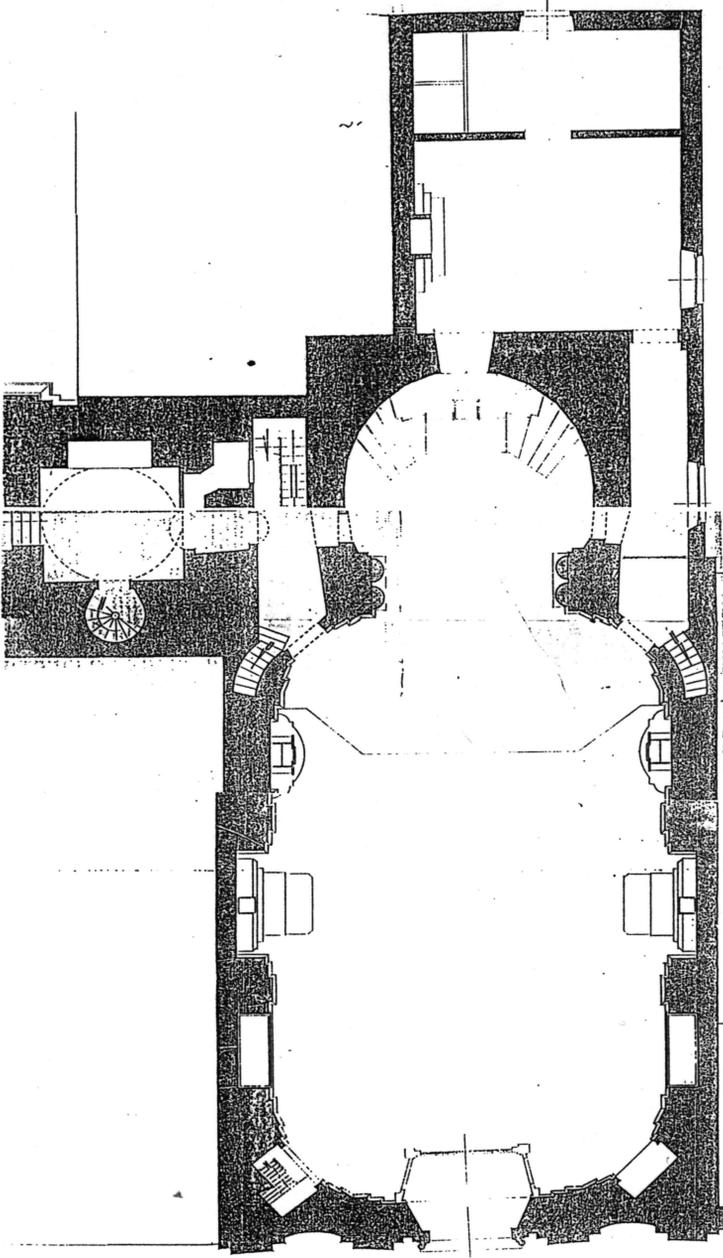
Foggia, Chiesa dell'Addolorata: planimetria (per gentile concessione dell'Arch. F. Onorati).
